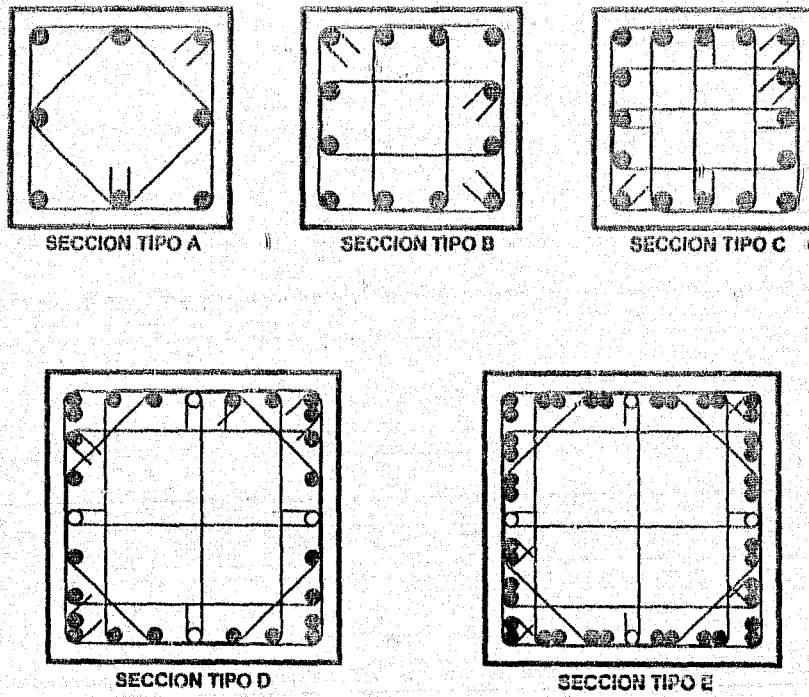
Refuerzo longitudinal y transversal en columnas marco convencional.
